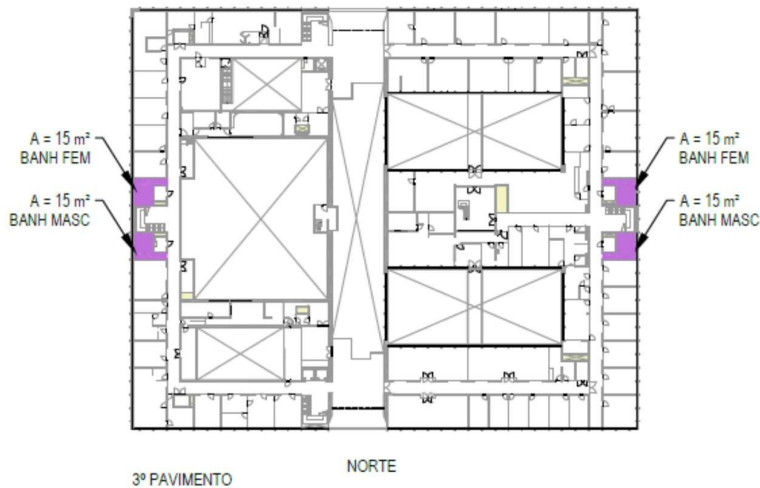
Indicação das áreas de intervenção dos 3 pavimentos
